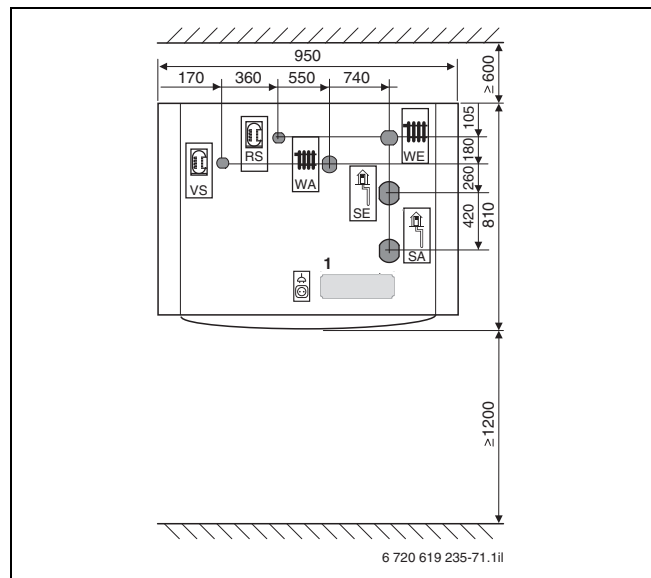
Abmessungen der Wärmepumpen Logatherm WPS 43 – 60 (Maße in mm)
